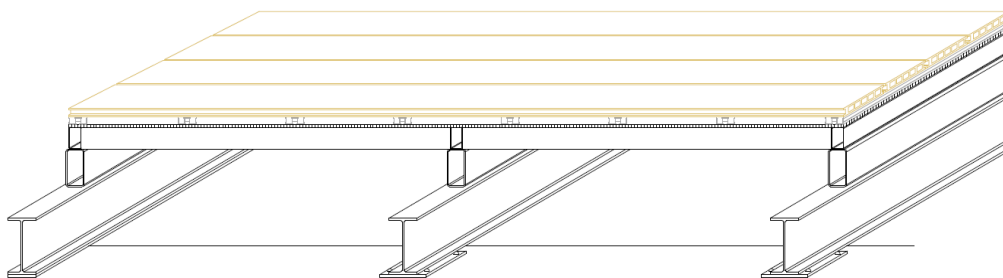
Detall constructiu en 3D de la passarel·la proposada.
